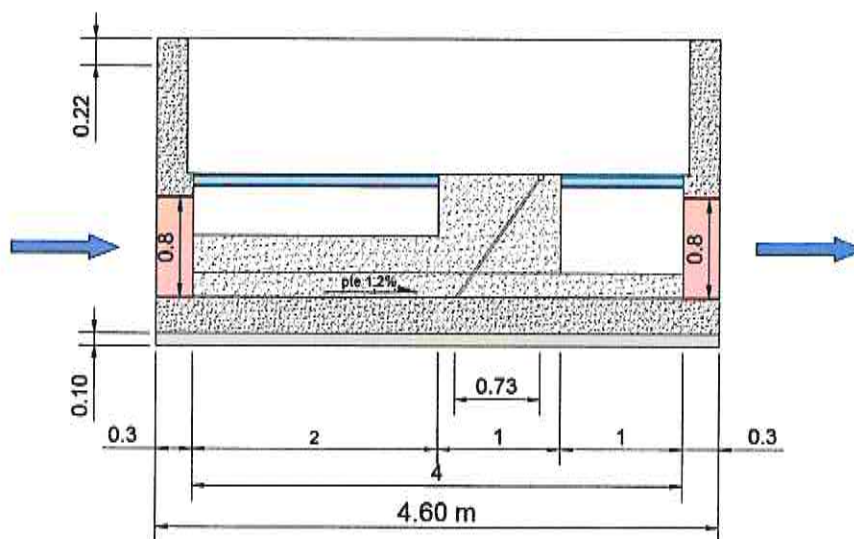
Planta de la arqueta, sentido del agua en azul. Fuente: Elaboración propia
